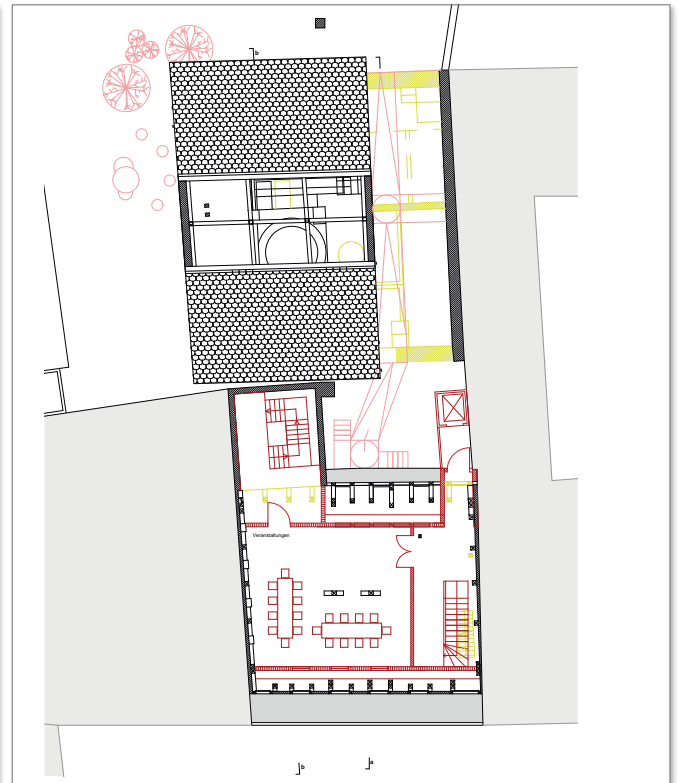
Malz- und Sudhaus, 3. Obergeschoss
